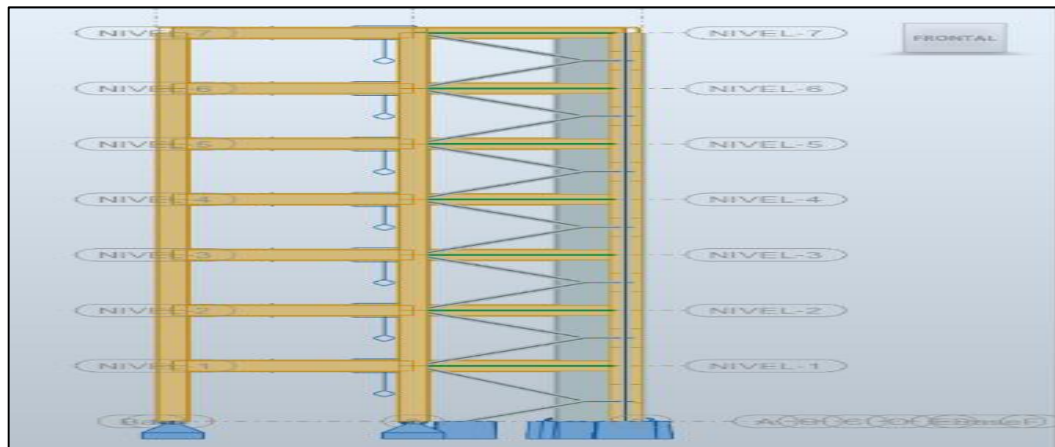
Elevación del modelo estructural del edificio elaborado en el programa BIM. Autodesk robot estructural. Fuente propia.
